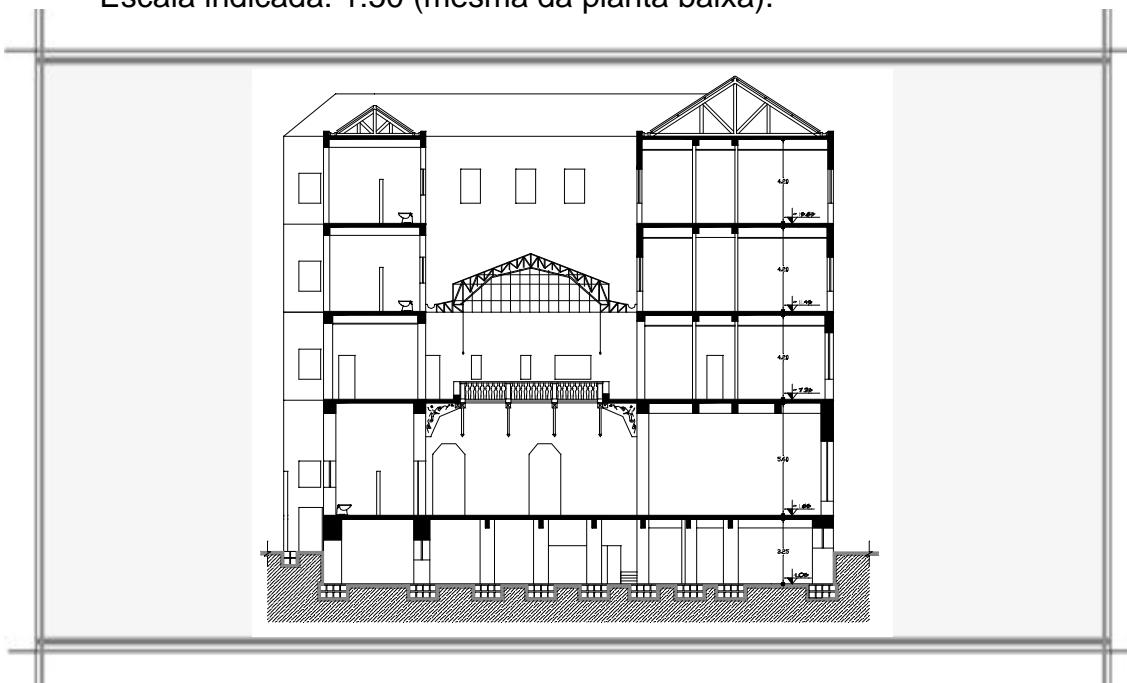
Corte Transversal. Desenho: Cristiane Müller.
